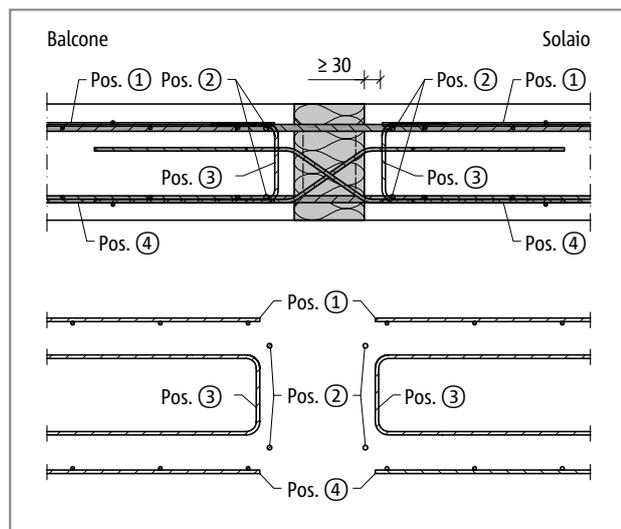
Schöck Isokorb® tipo DXT: armatura in opera
